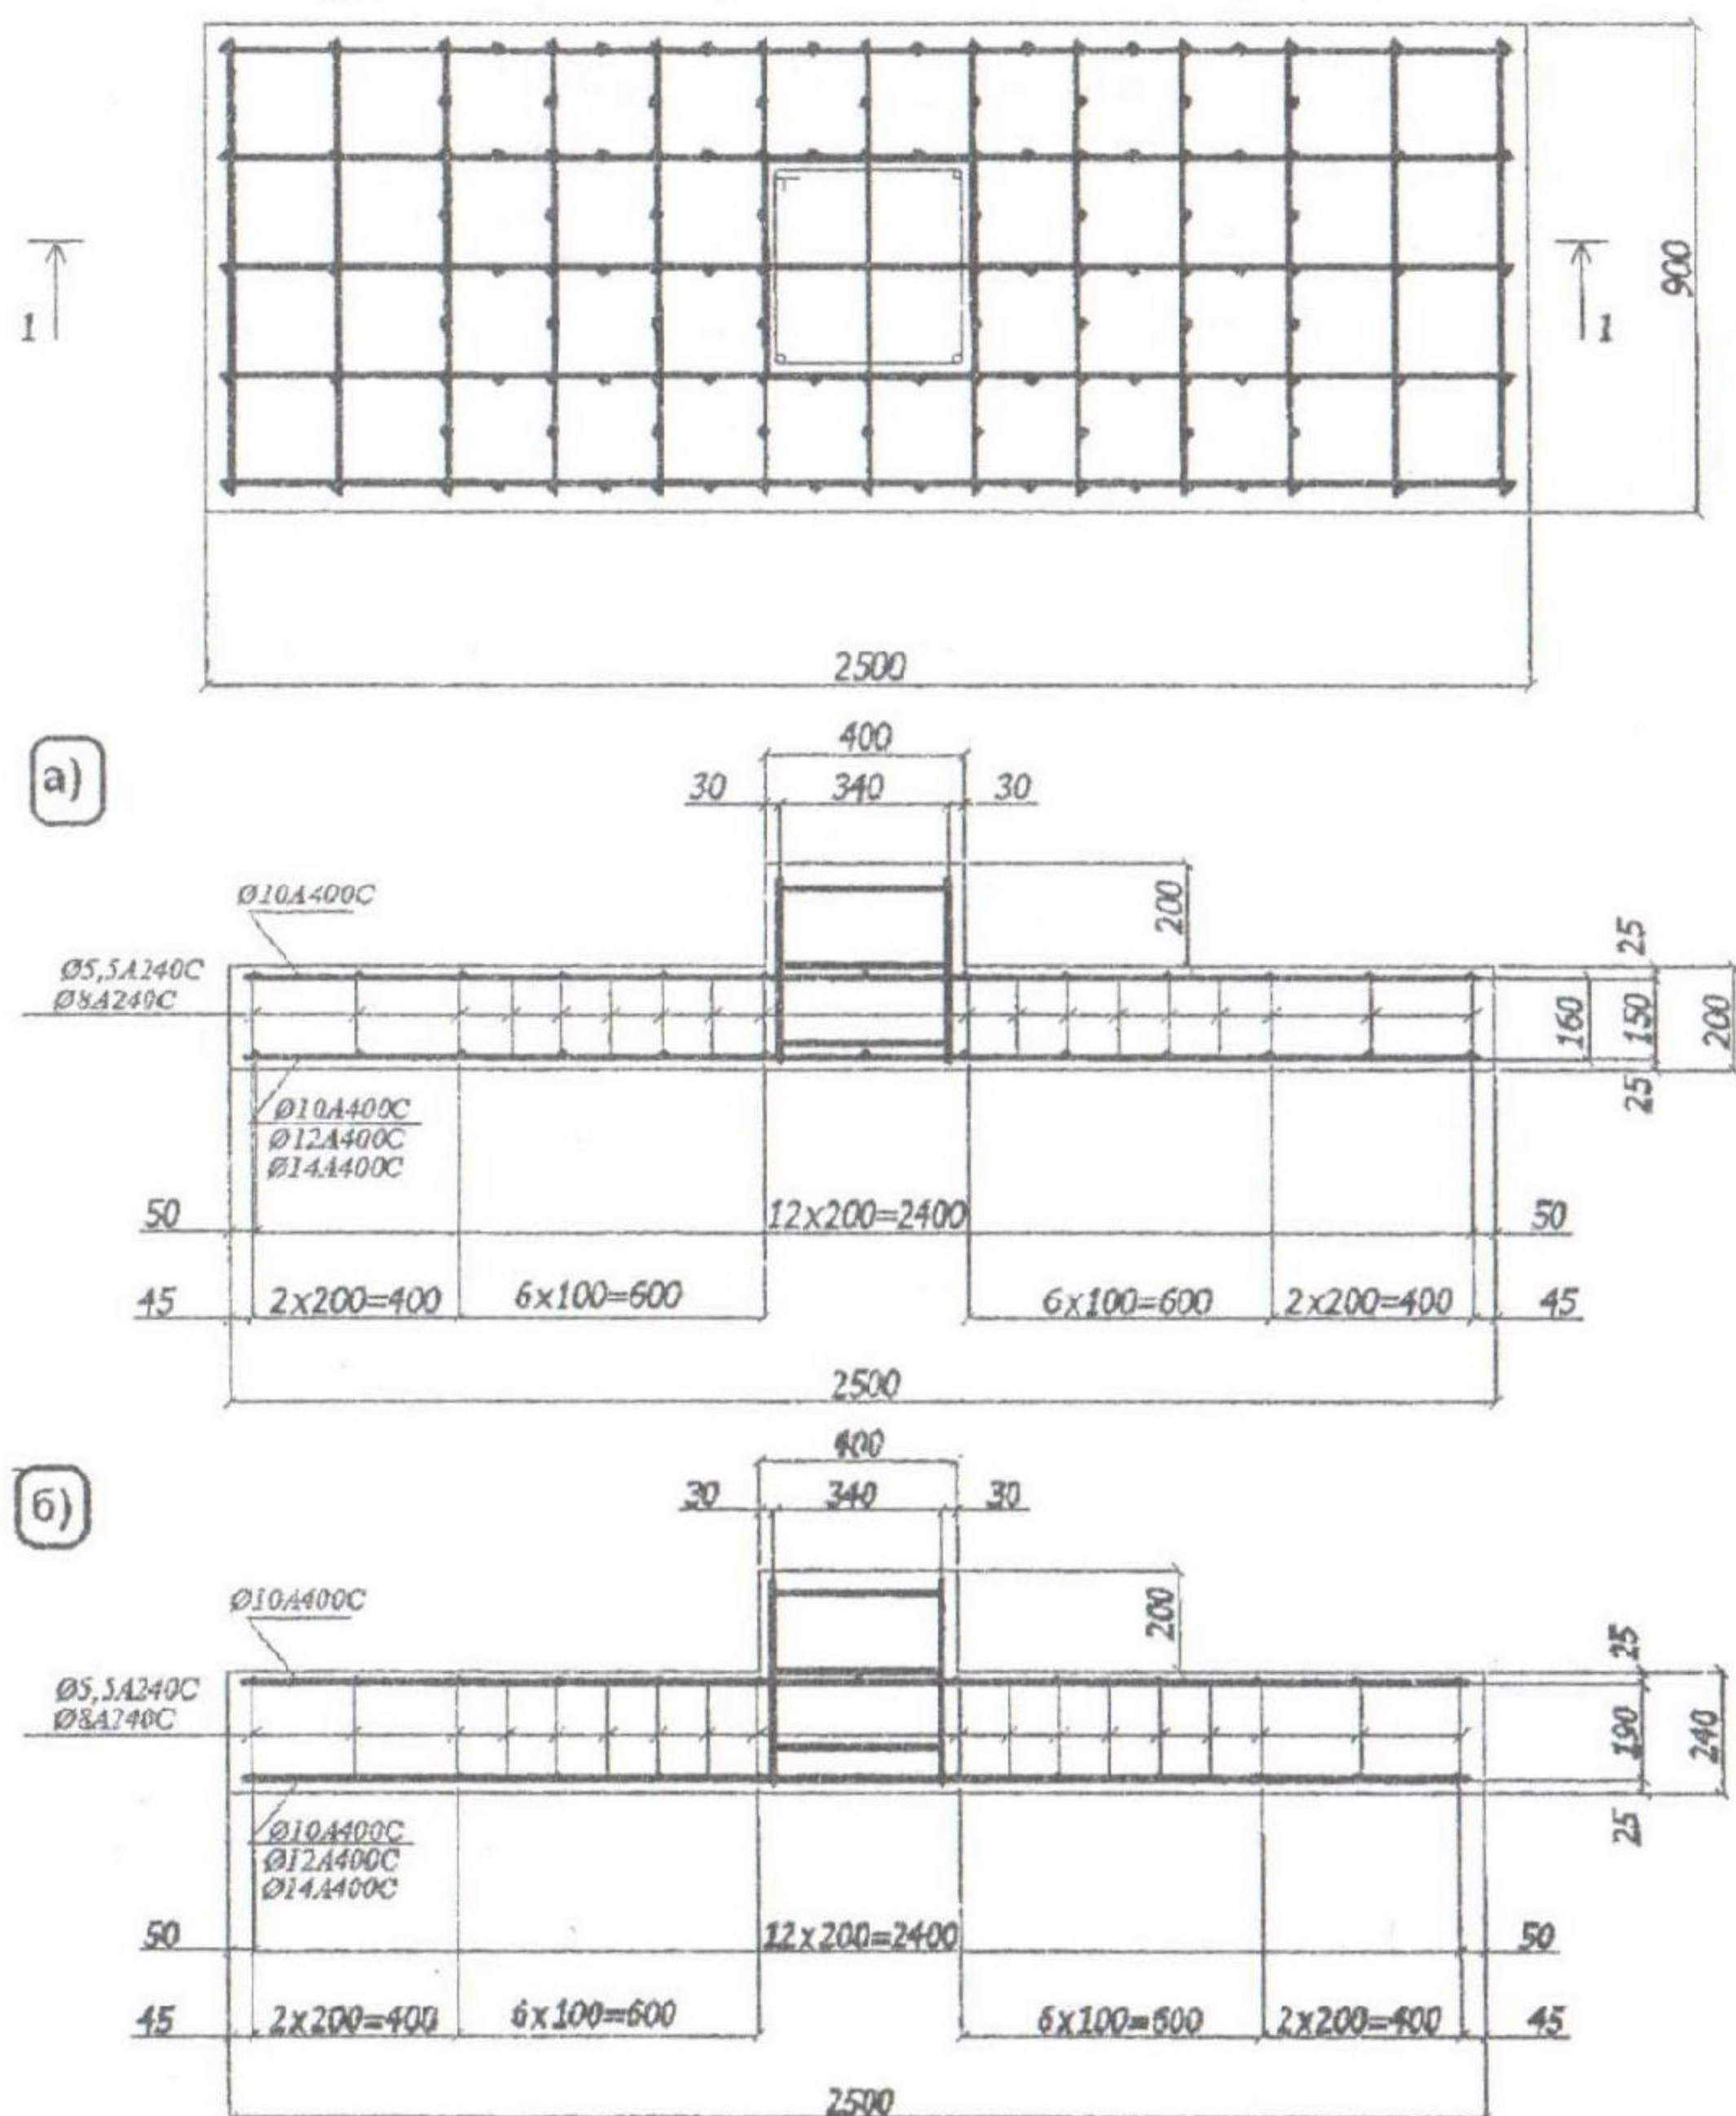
Конструкции экспериментальных образцов: а) – образцы Р 1...6; б) – образцы Р 6...12
